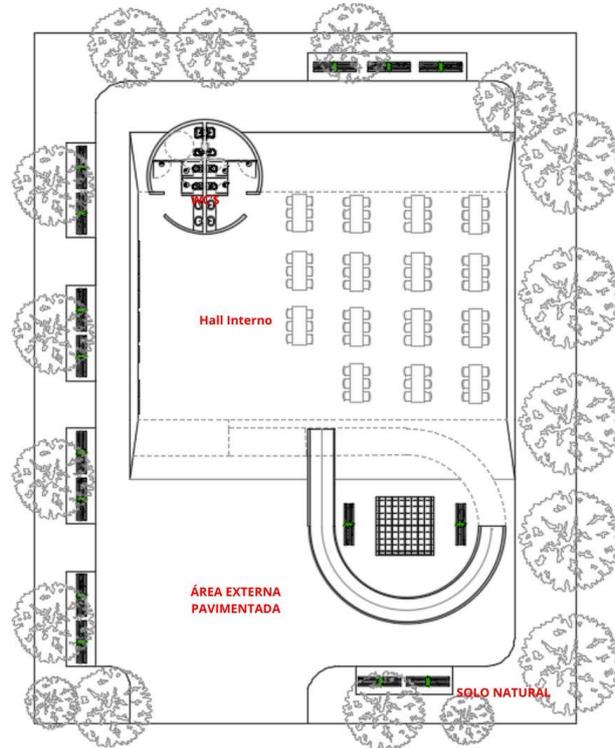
Estudo da planta baixa do pavimento térreo com disposição das mesas e Wc's
